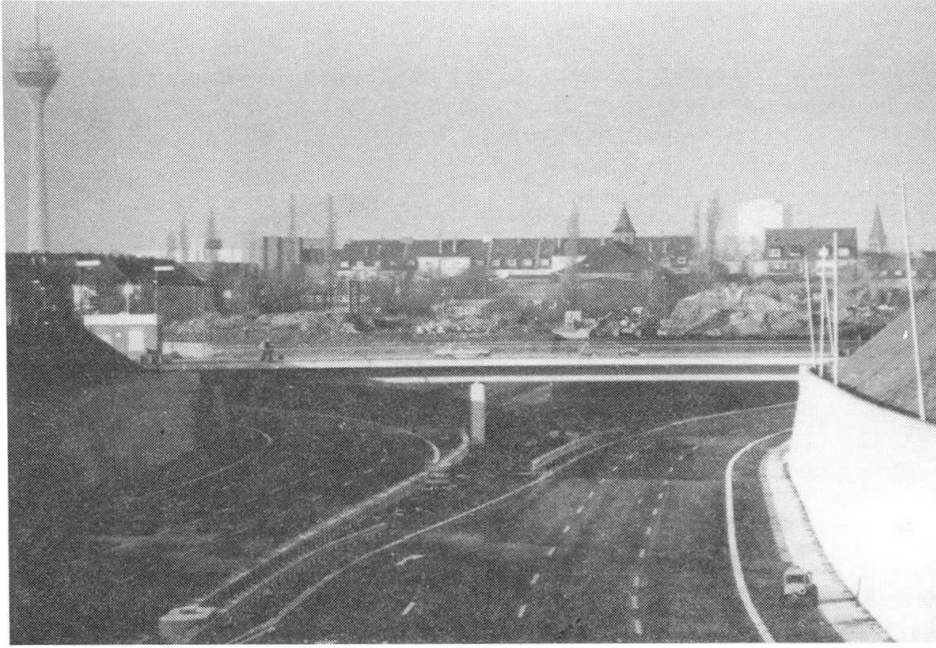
Gesamtaufnahme Brücke Ulenbergstraße, Düsseldorf
